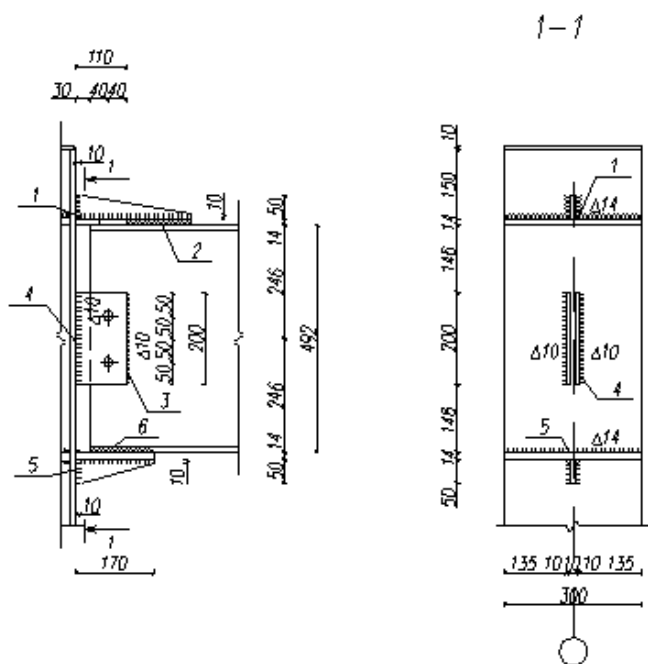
Вузол 2: Кріплення ригеля до колони виконуємо на зварюванні з допомогою пластин.
